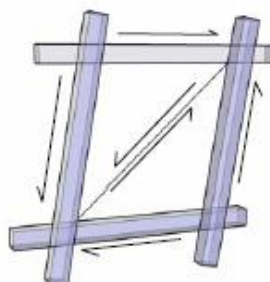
Elemento para transferência das forças de corte (Toussaint, 2007)
